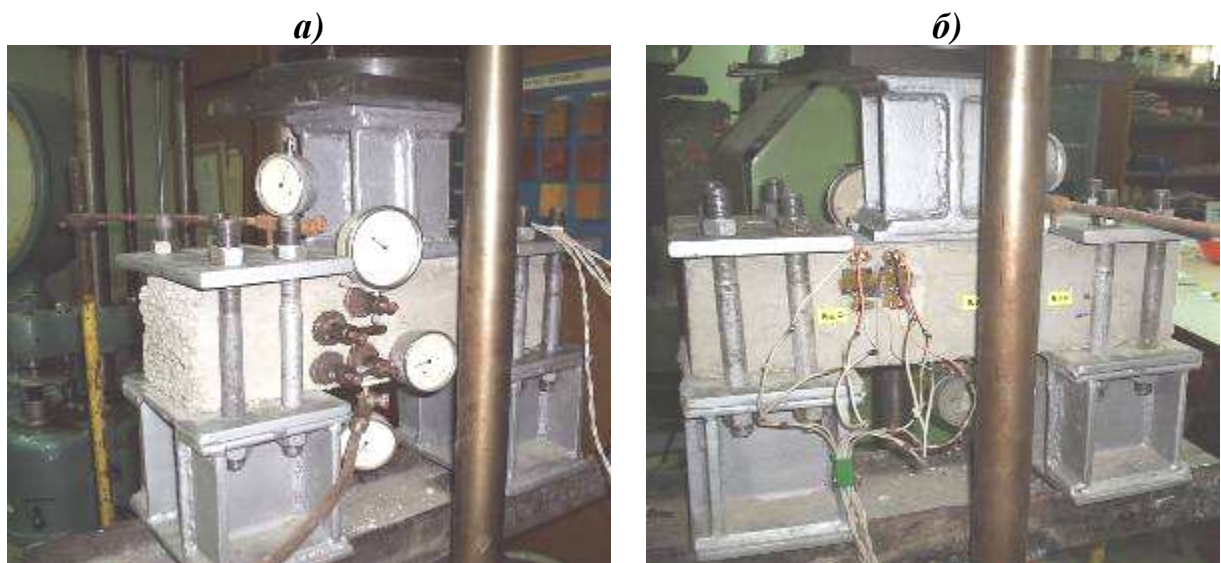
Схема розміщення механічних приладів (*а*) і установка ЕТ розеток (*б*) на складені бетонні (залізобетонні) призми з бетонів різних класів (C25/30- C25/30-C25/30; C16/20- C25/30-C16/20)
